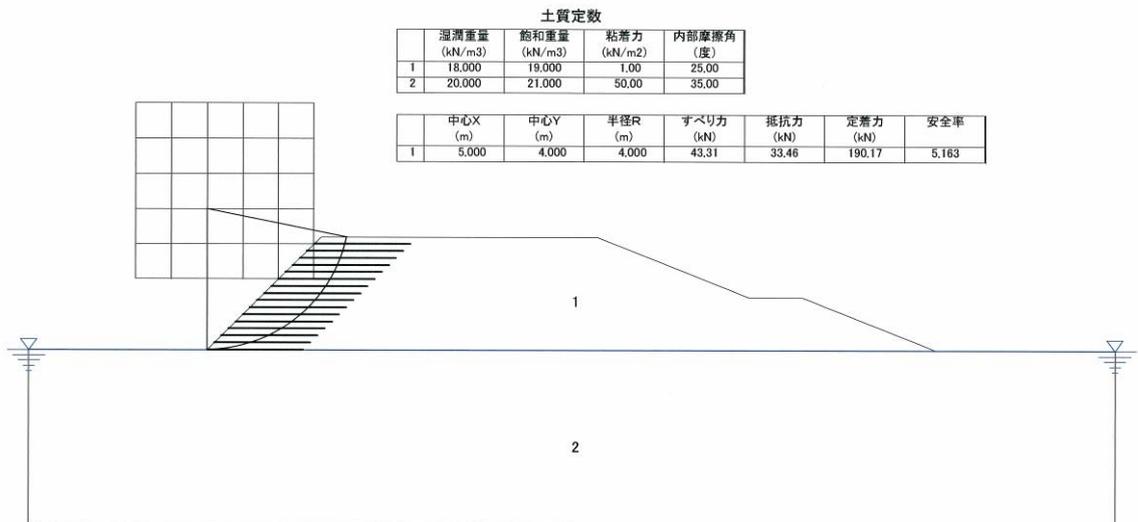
補強盛土の安定計算 (敷設長 L=2.700m)
